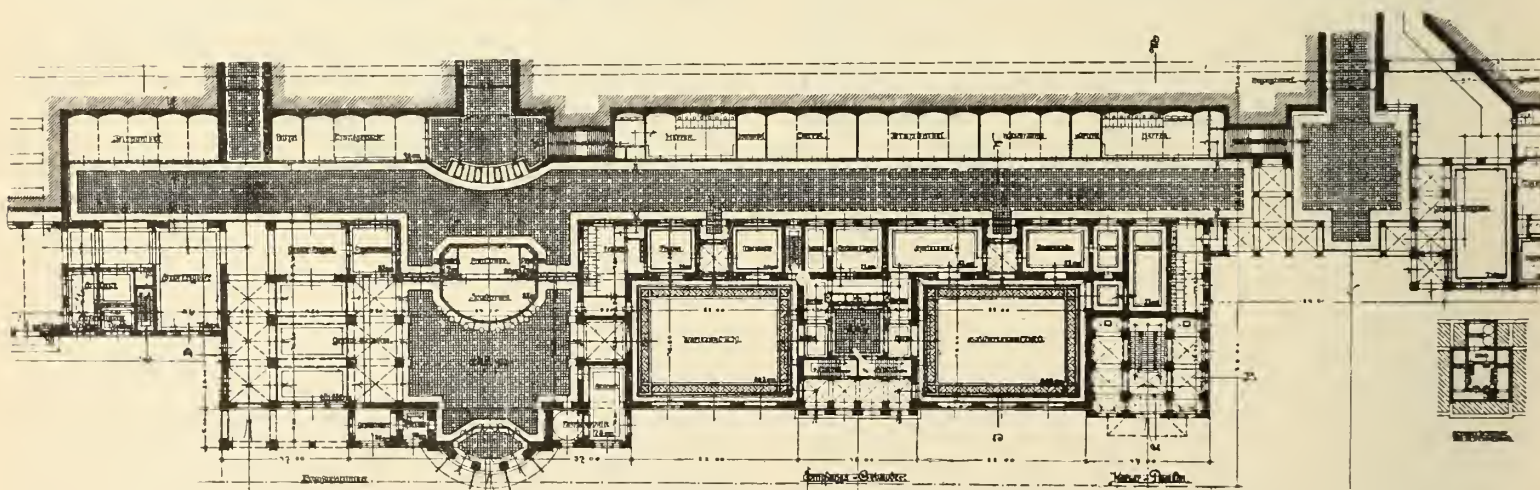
Grundriss des Entwurfs der Architekten Paul Brenkel und Aug. Koyen in Düsseldorf. (Angekaufter Entwurf.)
